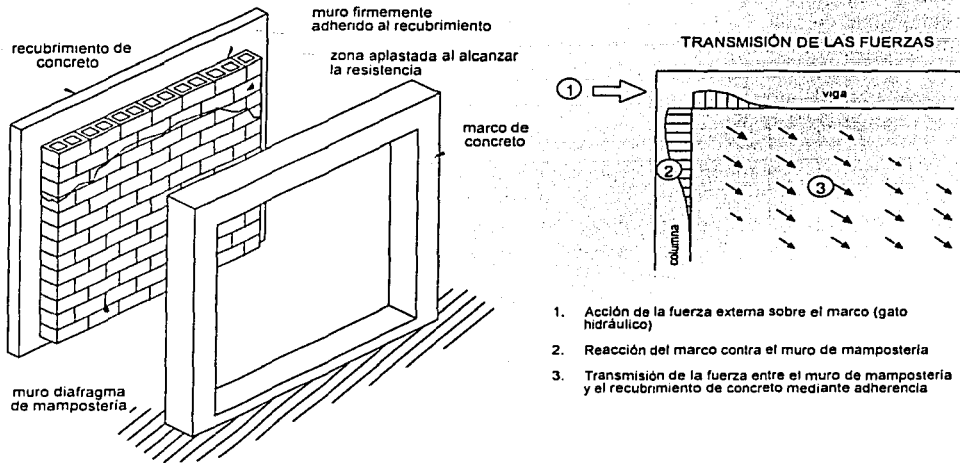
Esquema de el trabajo del muro de mampostería como llave de cortante
